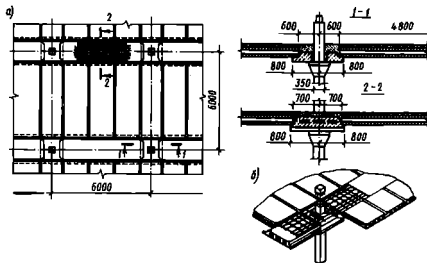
Сборно-монолитное безбалочное перекрытие с напряженно-армированными плоскими ригелями, многопустотными плитами и плоской капителью:
